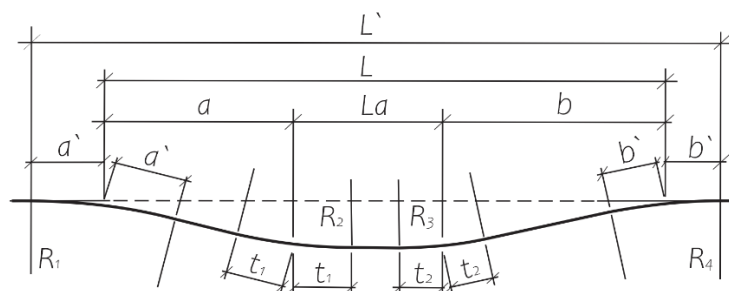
Elementet teknike minimale horizontale të vendndaljes së autobusit
